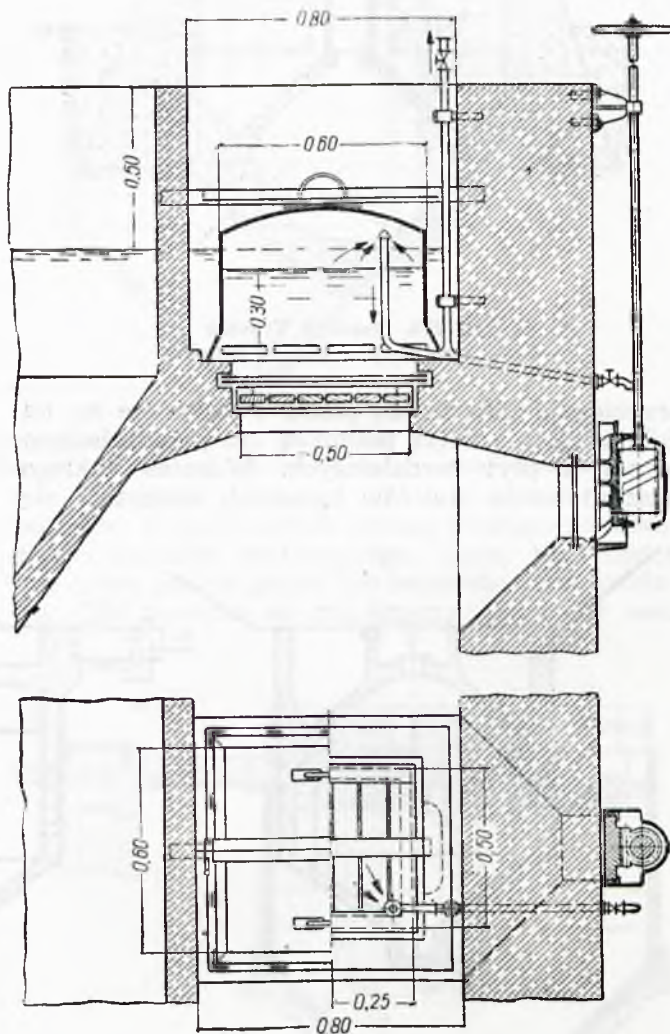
Osadnik Imhoffa ze zmiennym kierunkiem przepływu
